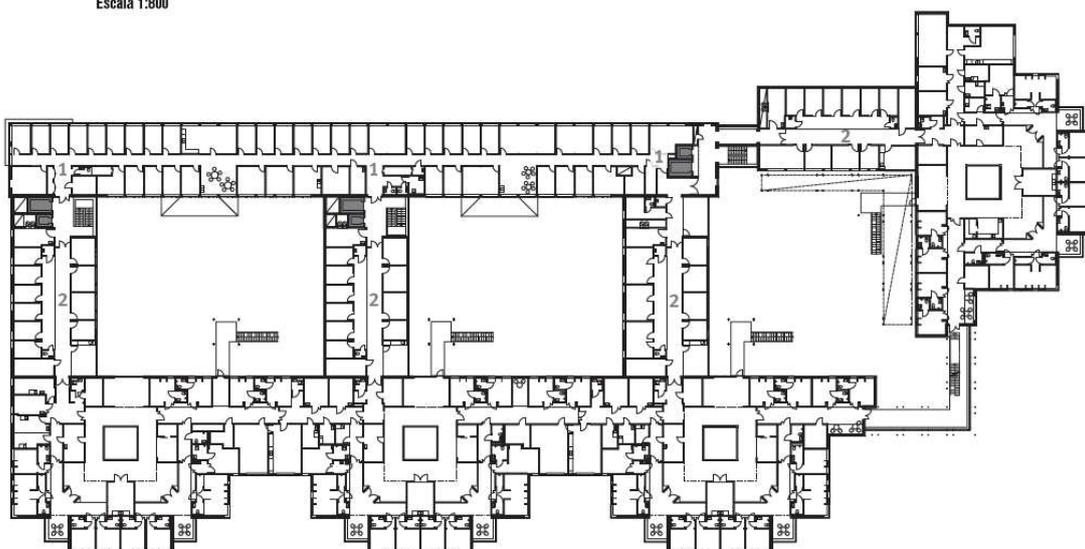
e 19, respectivamente: Plantas baixas do terceiro e quarto pavimento
